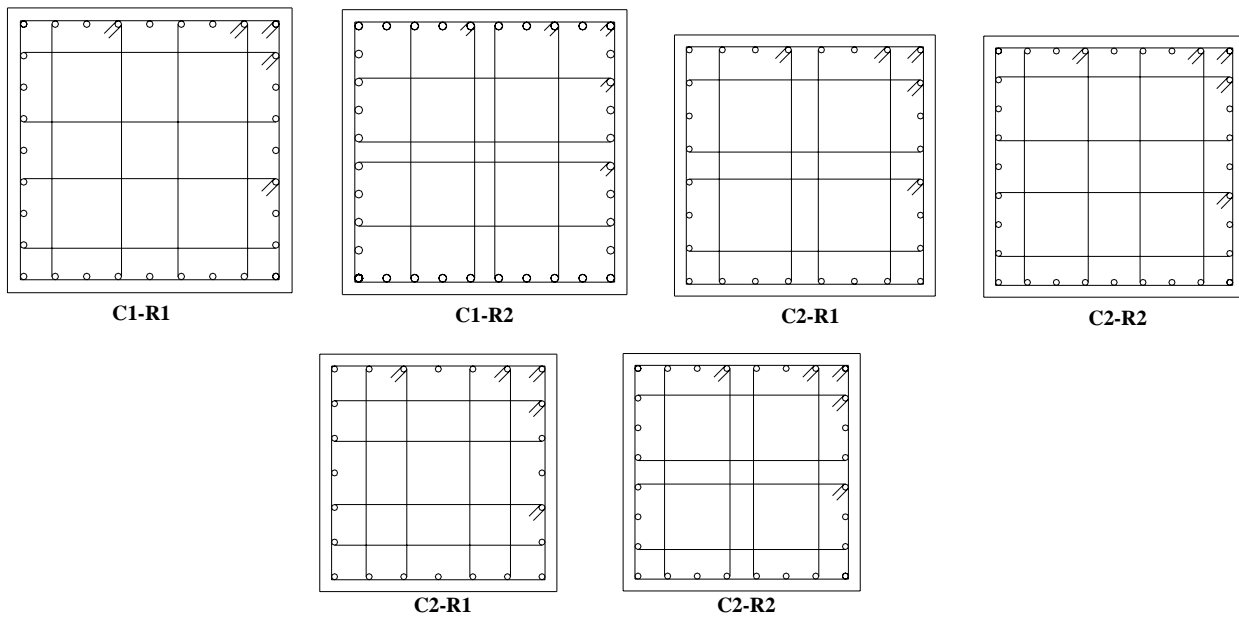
Secciones y refuerzos de las columnas del modelo M1Q4AA
